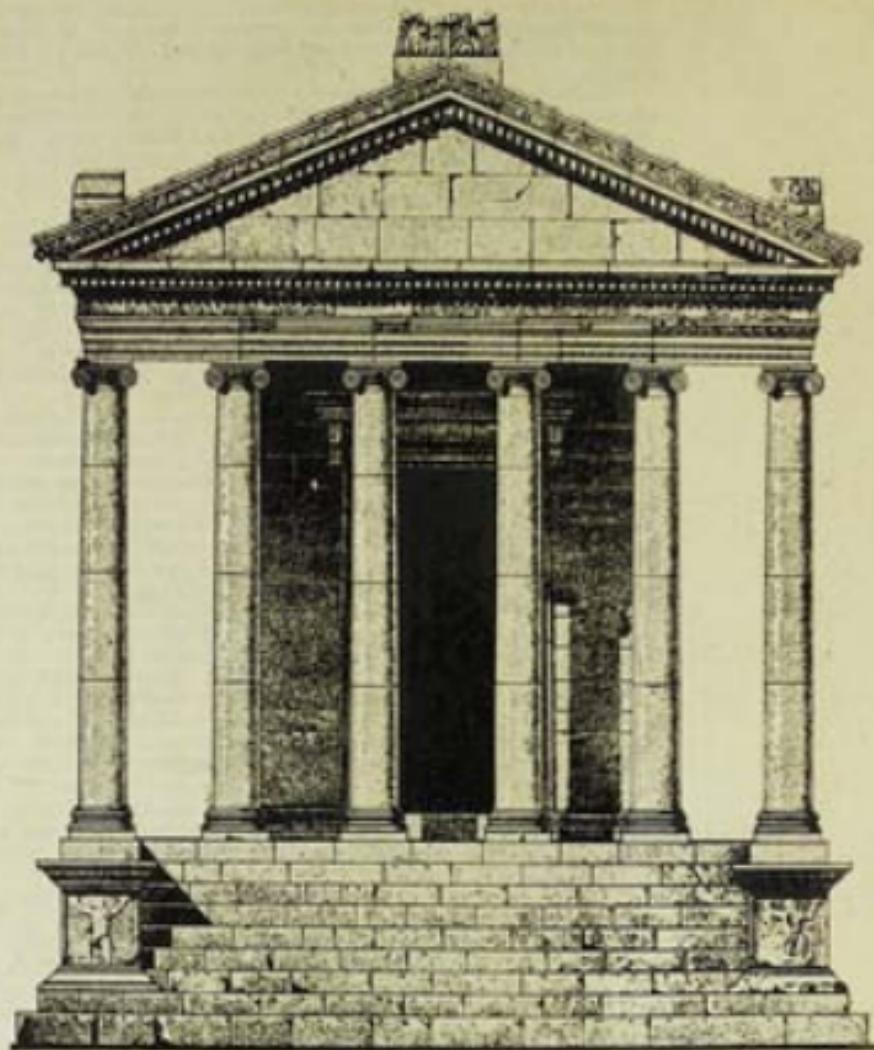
Герод: афинский храм — спереди фасад. Реконструкция
